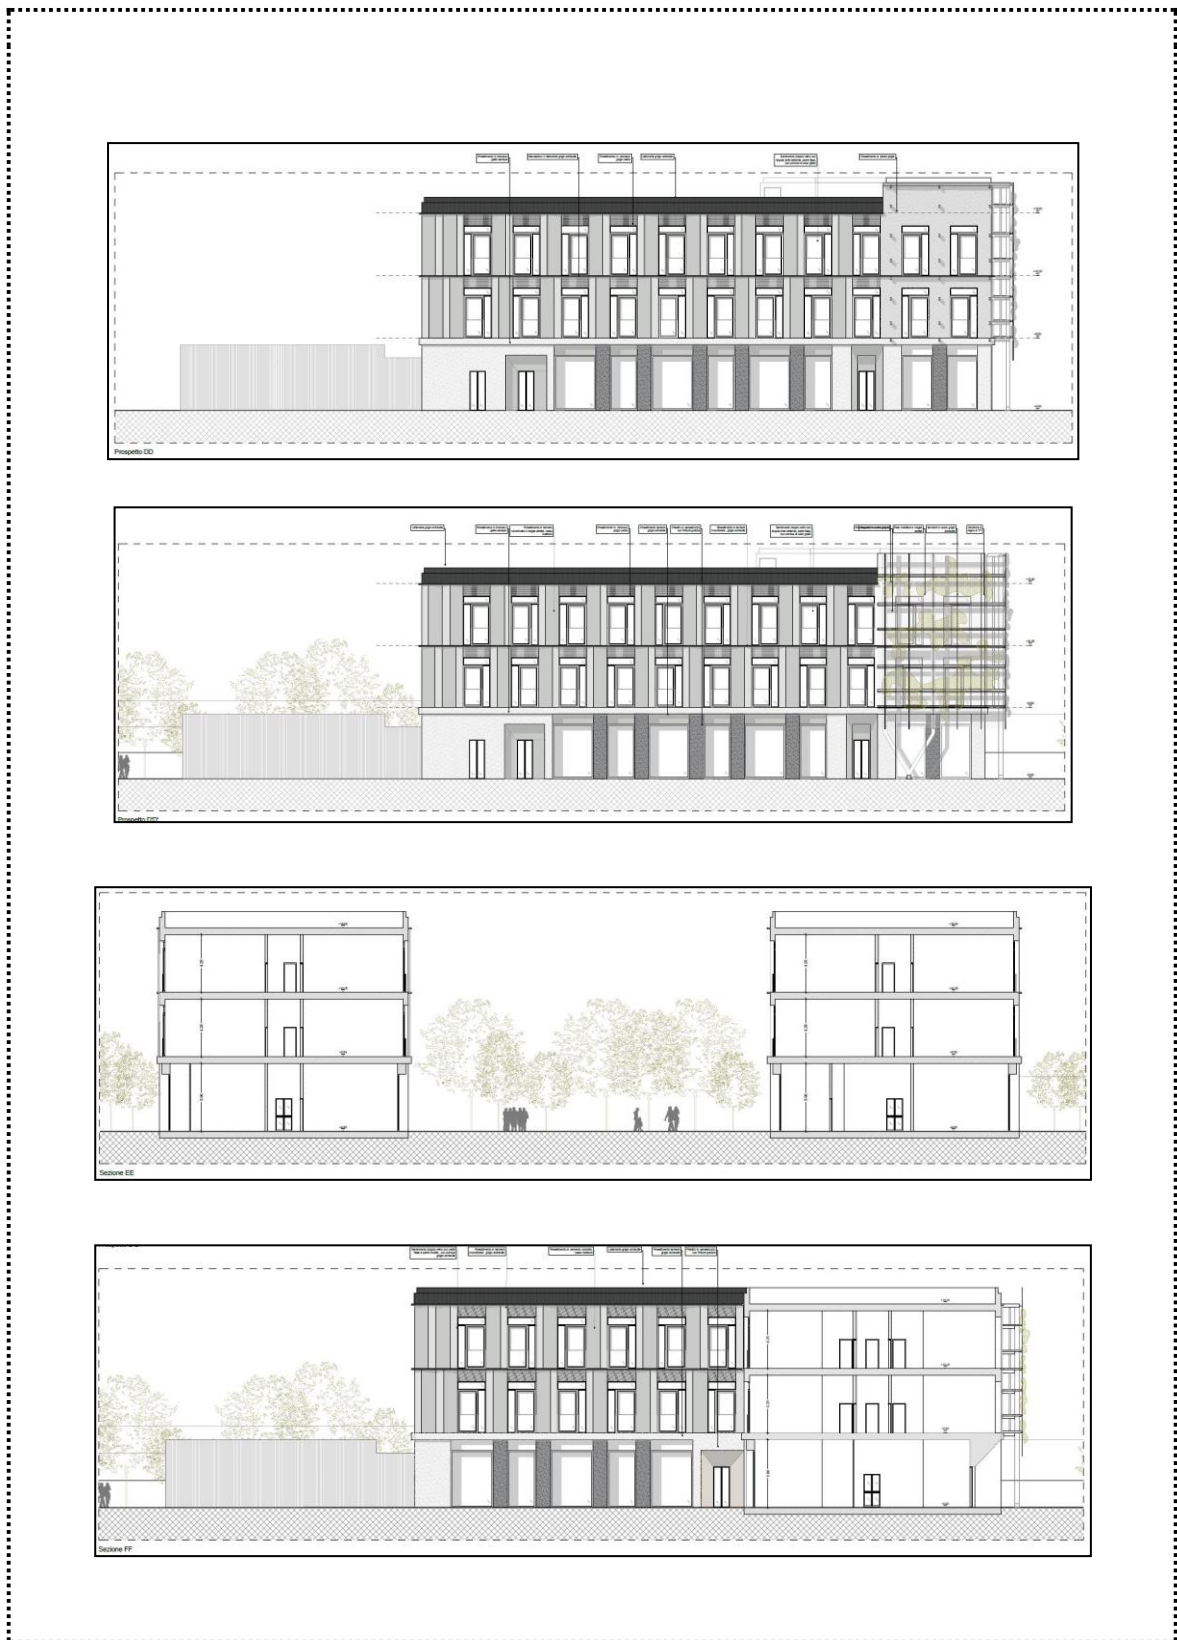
Estratti tavole di progetto – prospetti e sezioni (T.12)
